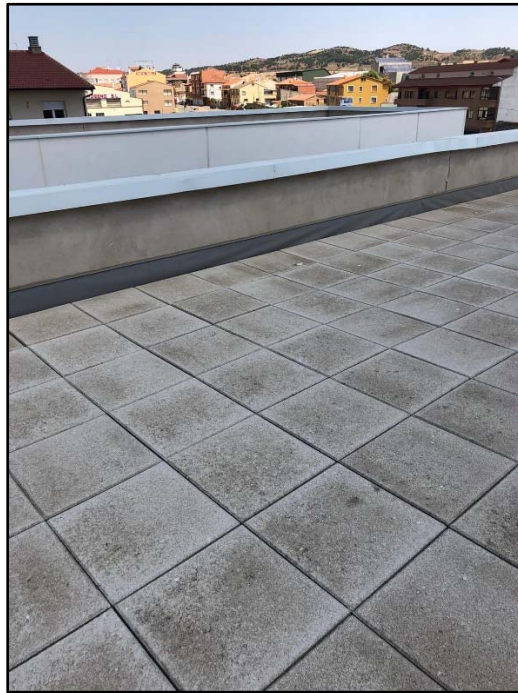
Cubierta tipo existente para la ubicación de los paneles fotovoltaicos.
